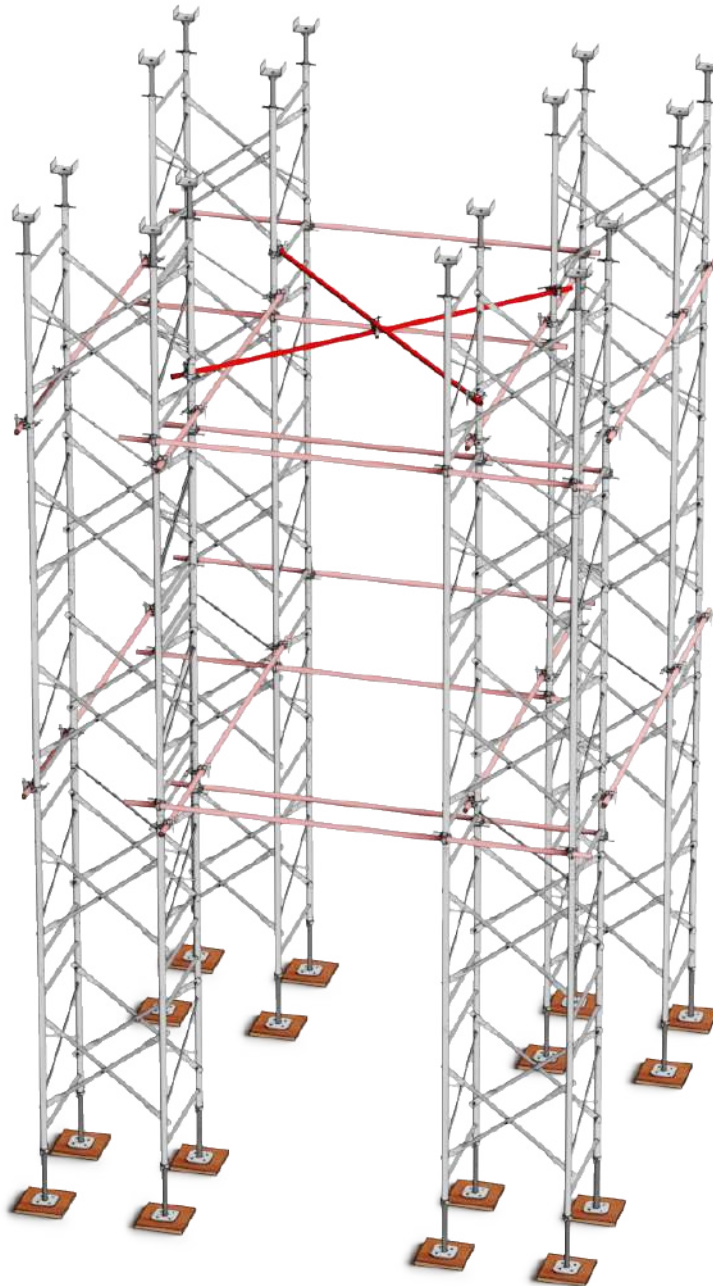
Contraventamento em Torres com Tubo e Braçadeira
